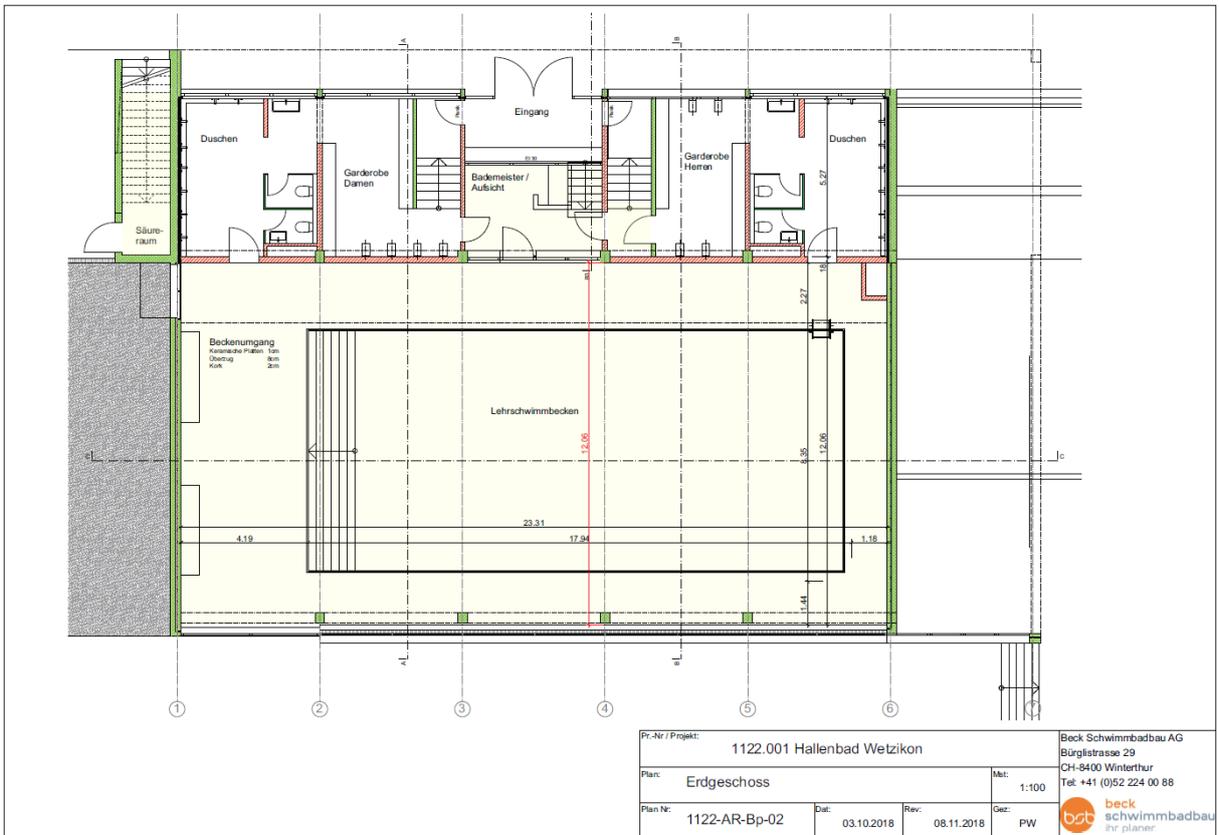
Grundriss Erdgeschoss (der Perimeter der Sanierung ist gelb markiert)
